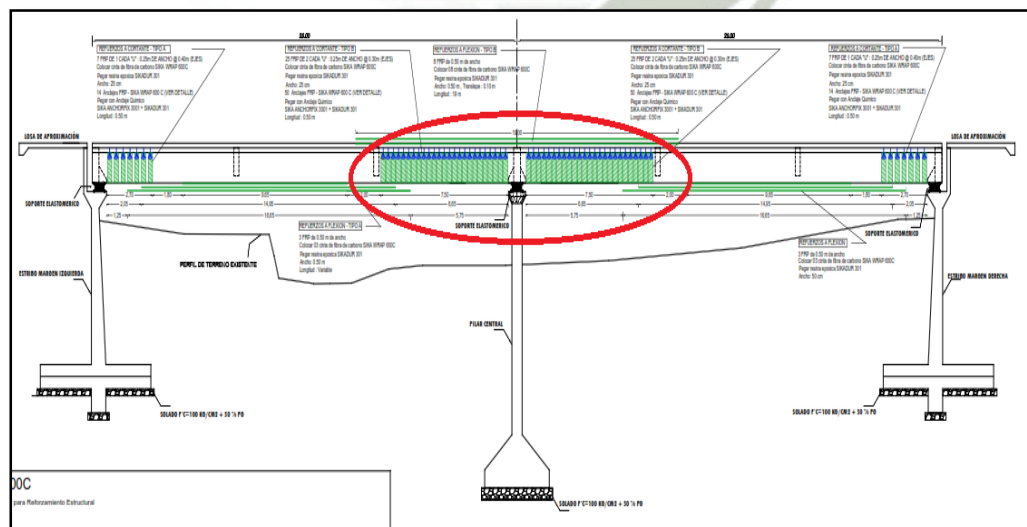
Detalle de reforzamiento por corte en pilar.
